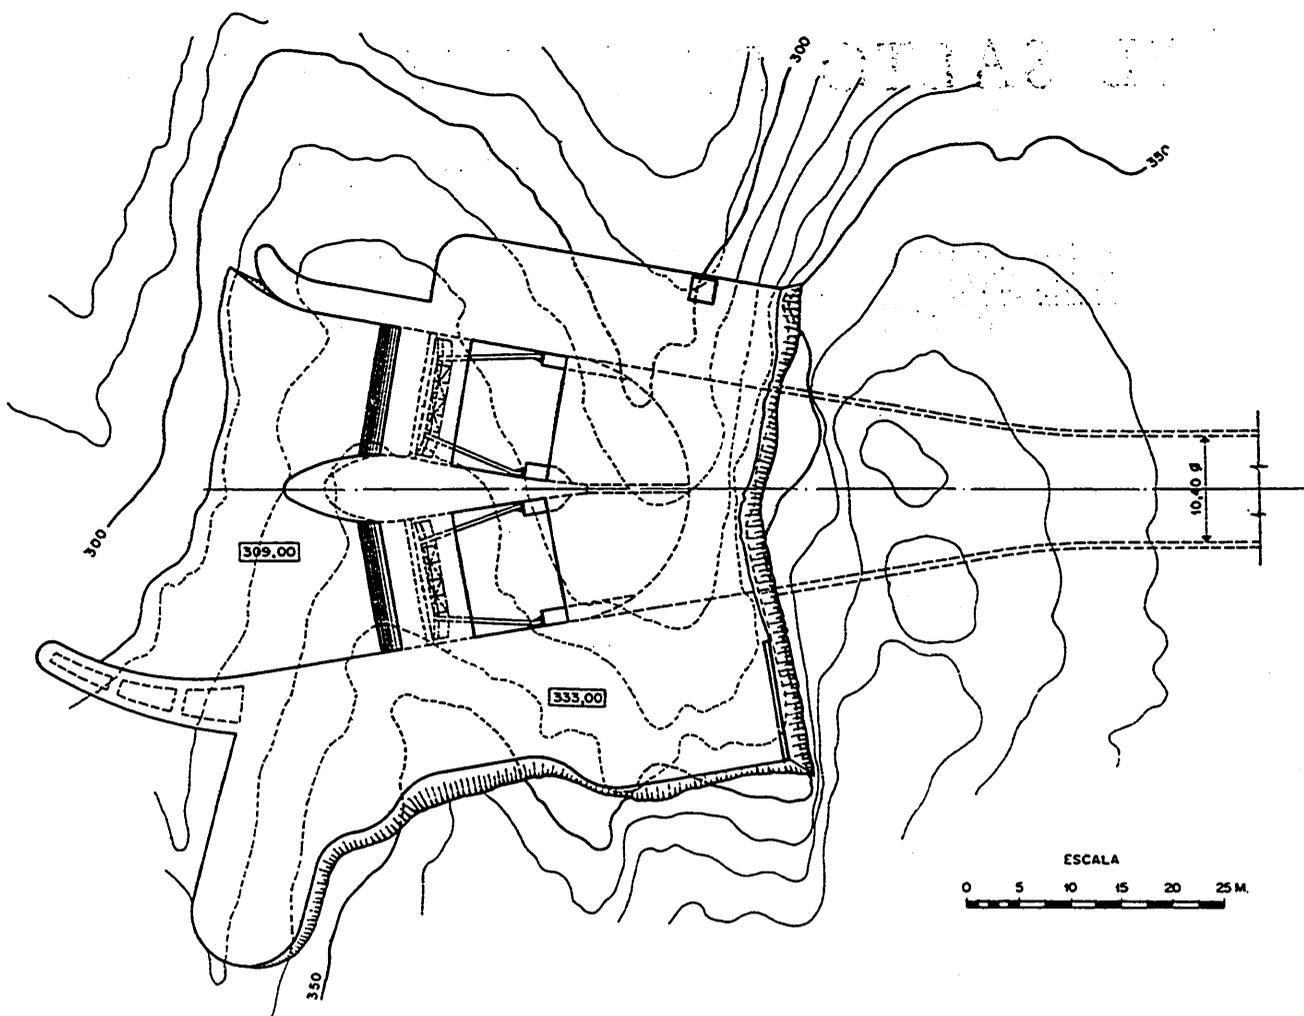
Túnel aliviadero. Planta de la embocadura.
